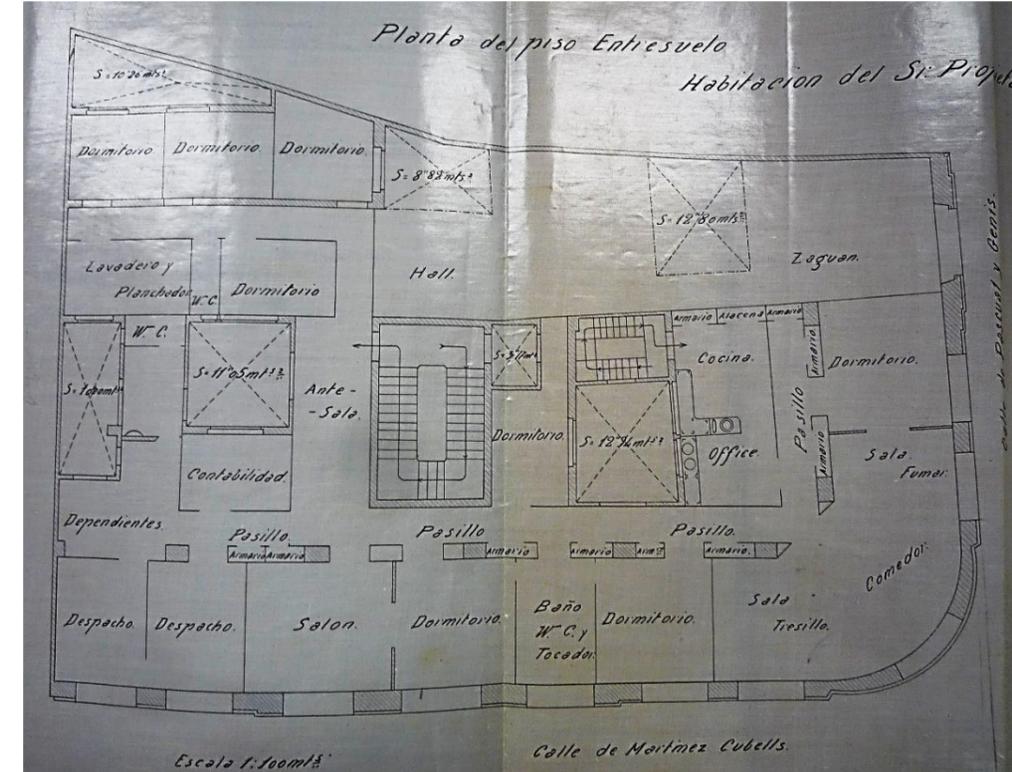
Plano original Planta Entresuelo "Planta del Propietario"
